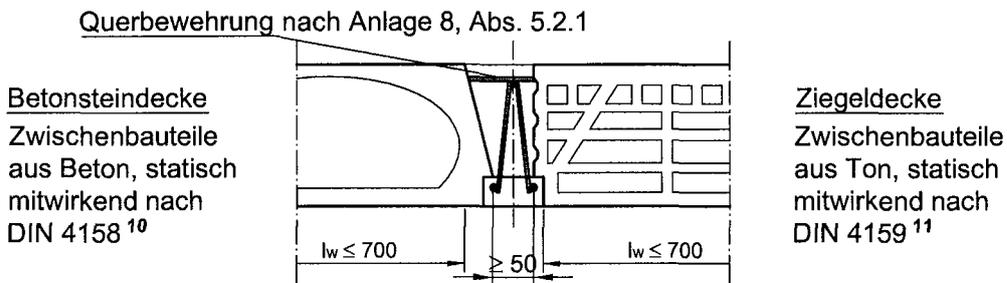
Rippendecke nach Anlage 8, Abschnitt 5
